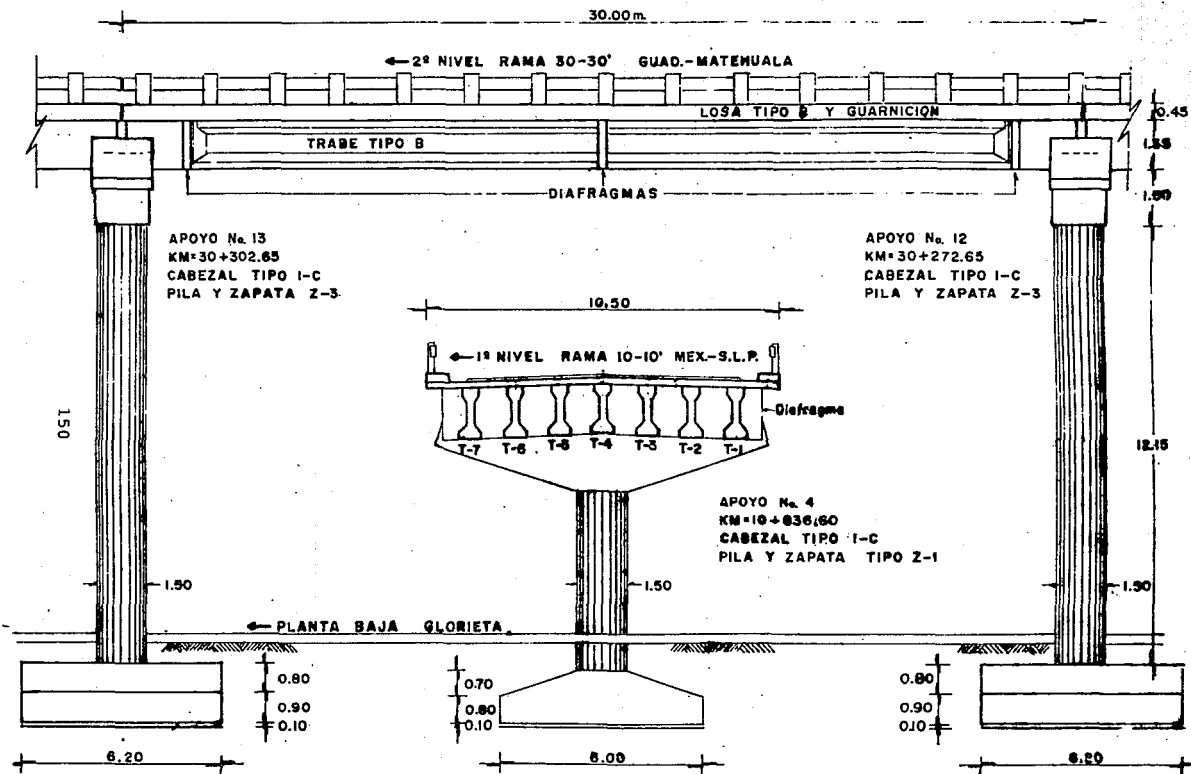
CORTE Y VISTA A-A' (CROQUIS V.1.4.2.1 Y V.1.4.2.2)
